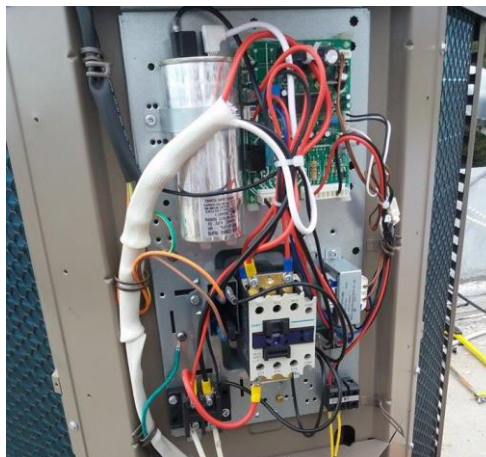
Verificación de la cubierta de rubatex (aislamiento térmico)
